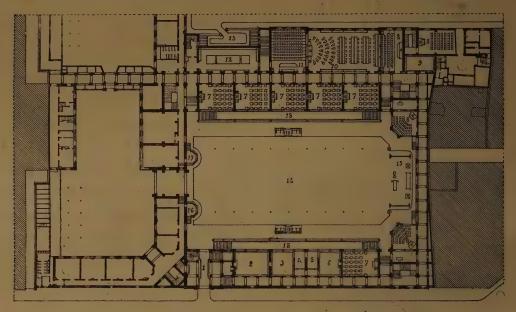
Collège Sainte-Barbe, à Paris, plan du rez-de-chaussée. — Échelle de 0m,001 par mètre.
